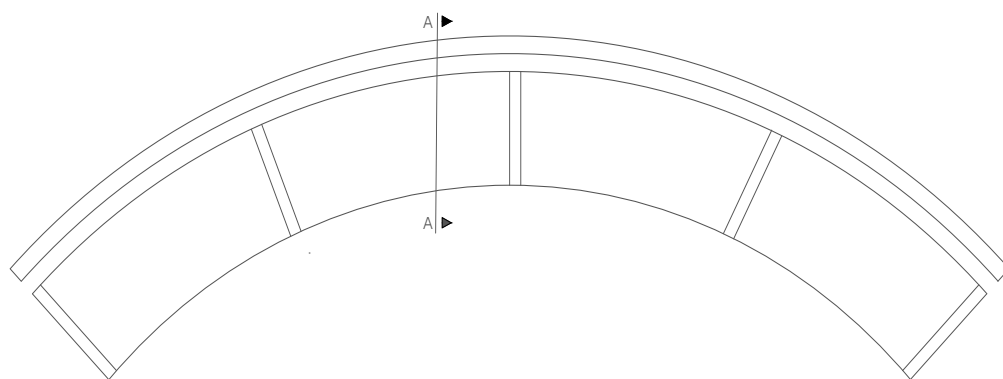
Detalle constructivo 2. (Redrován, 2024).
